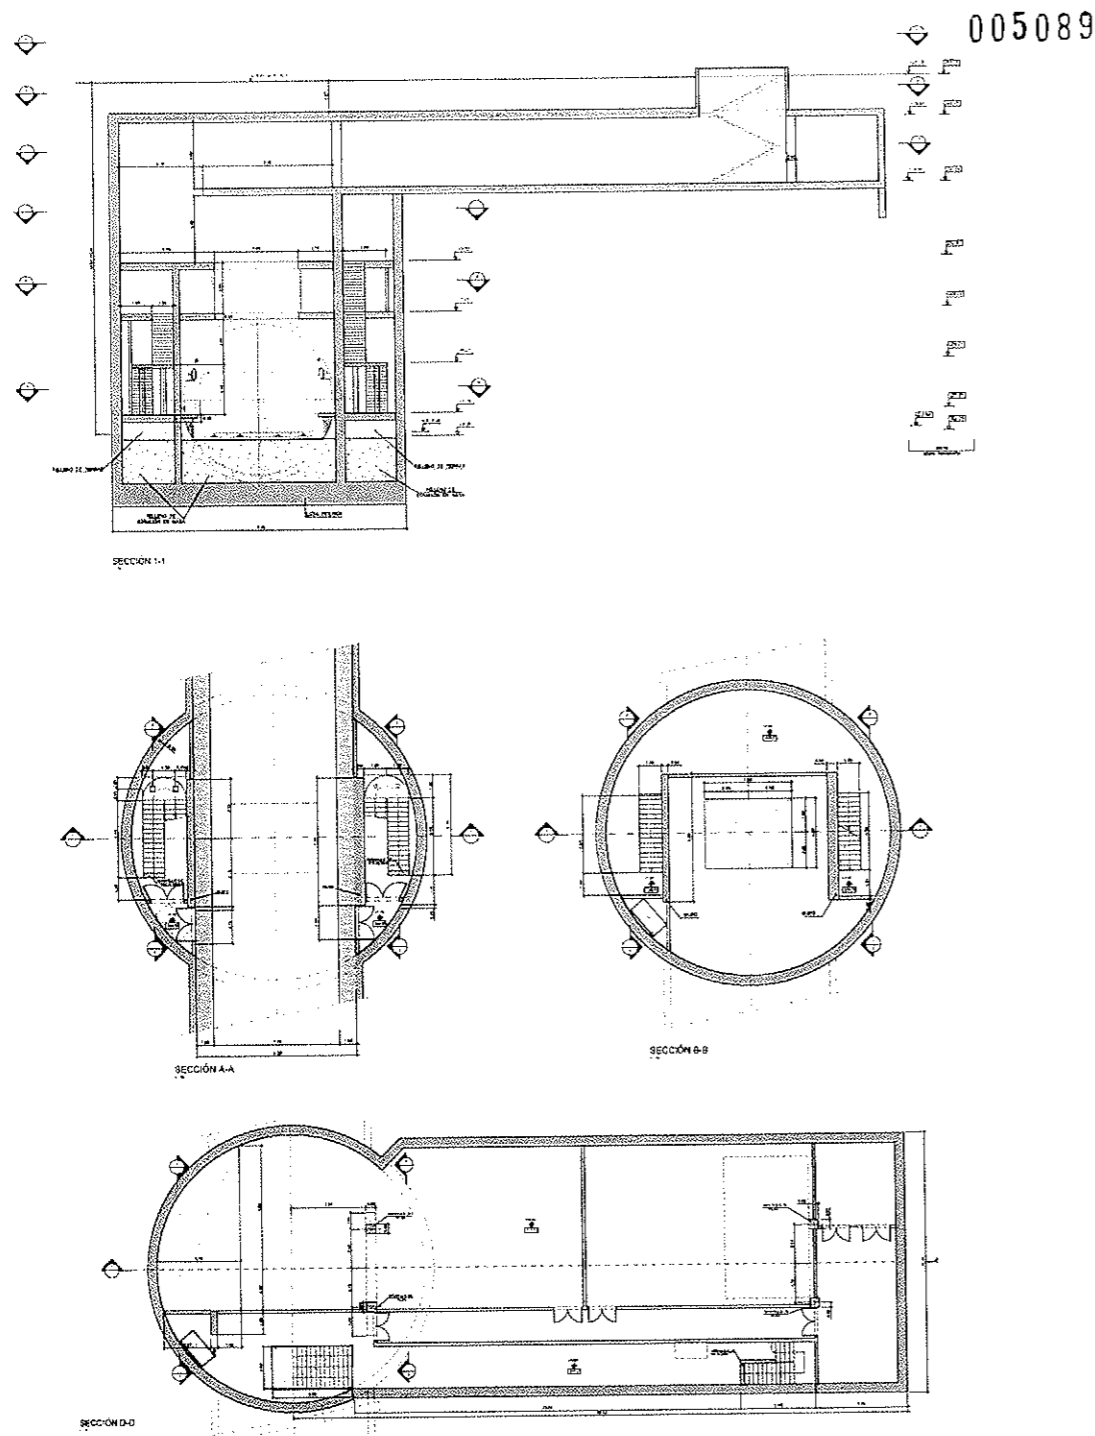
Sección transversal y plantas del pozo de ventilación y emergencia cenital
